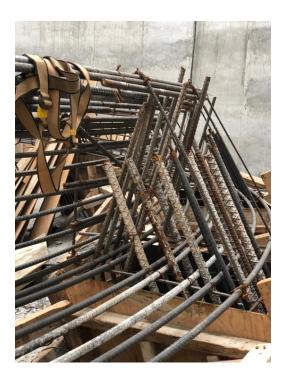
Acero de trabe de losa de concreto reforzado de cono del silo no. 14.
